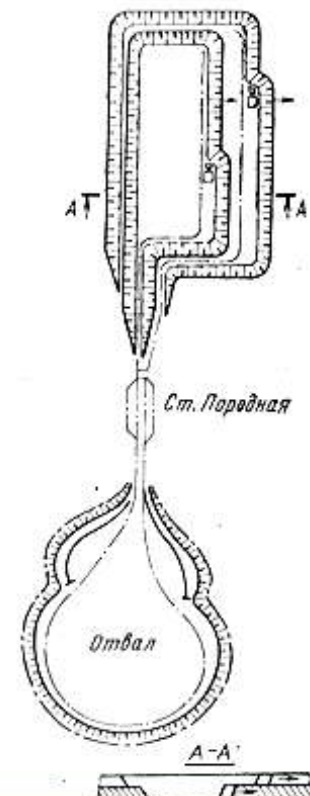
Вариант транспортной системы при разработке горизонтального пласта
